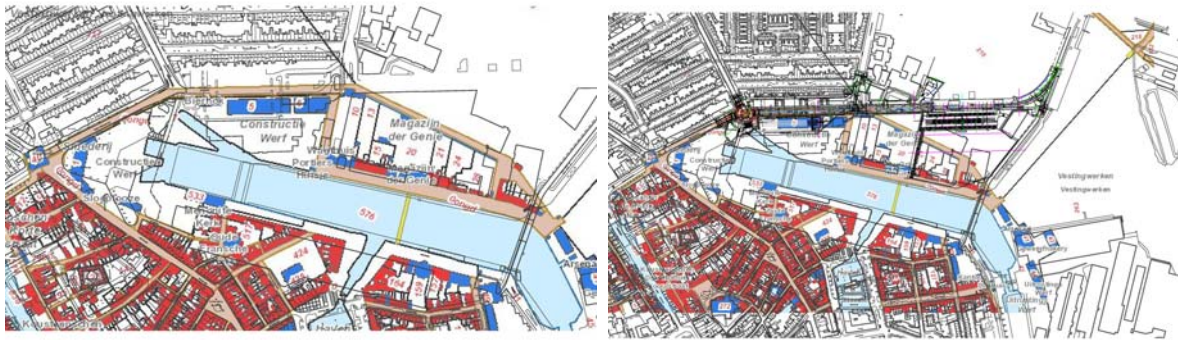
Plangebied op de kadastrakaart van 1832 met en zonder situatietekening
